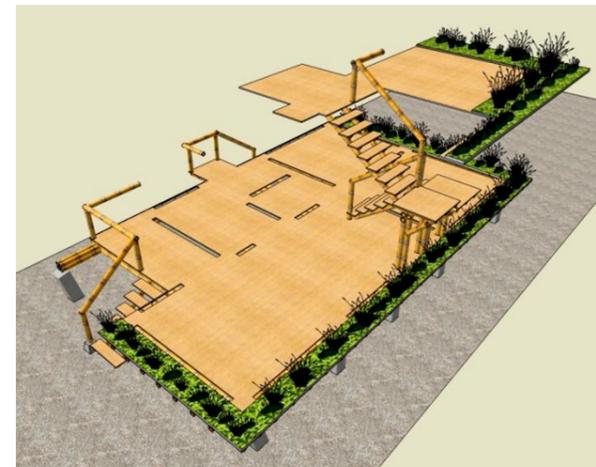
Piso de planta baja y planta alta con los espacios exteriores destinados a áreas verdes cultivables.
